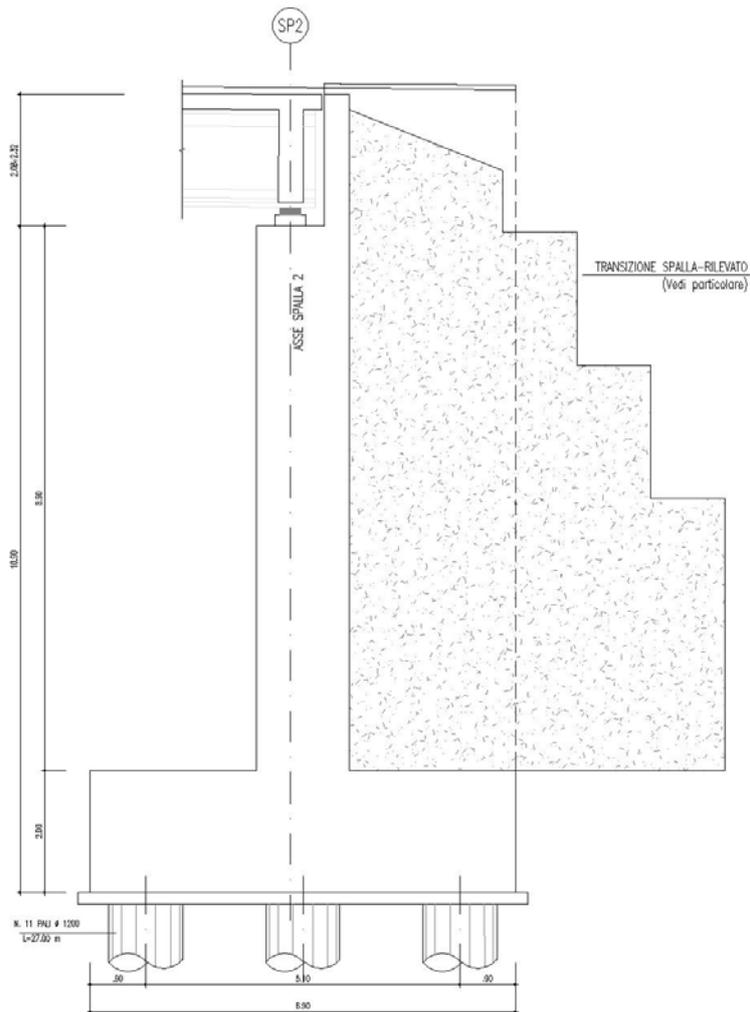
Sezione longitudinale della spalla 2.
